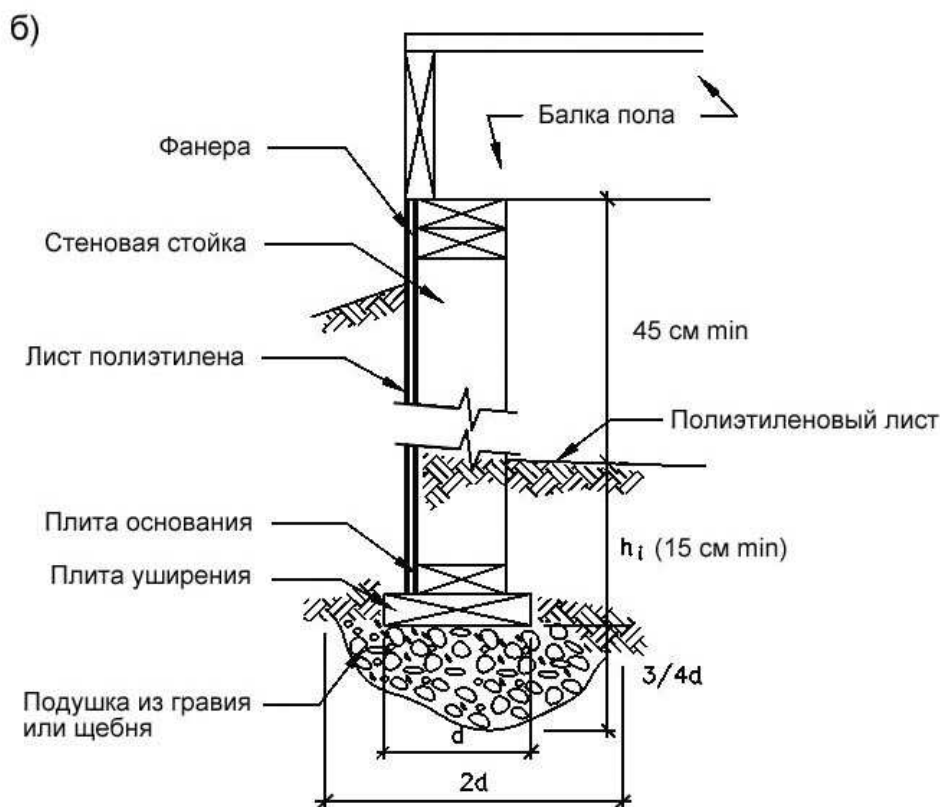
Схемы фундаментов из обработанных консервантом деревянных конструкций:
